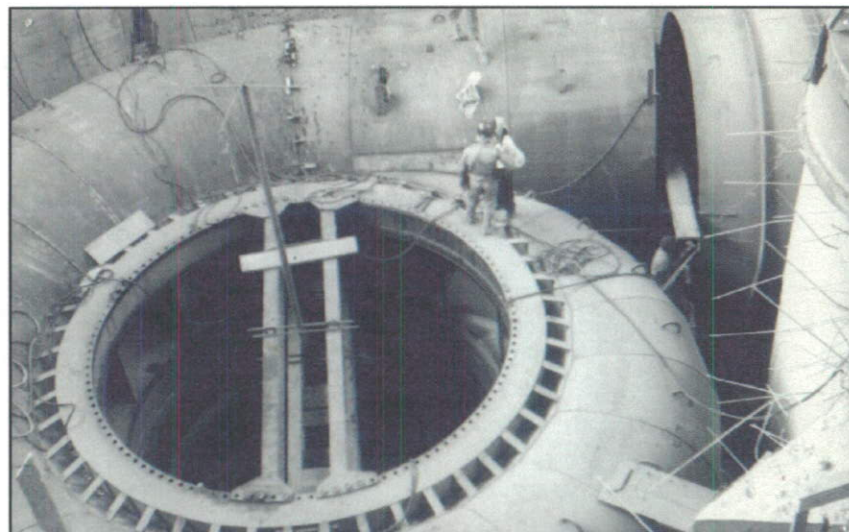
Vista da colocação das turbinas (FONTE: FURNAS).
